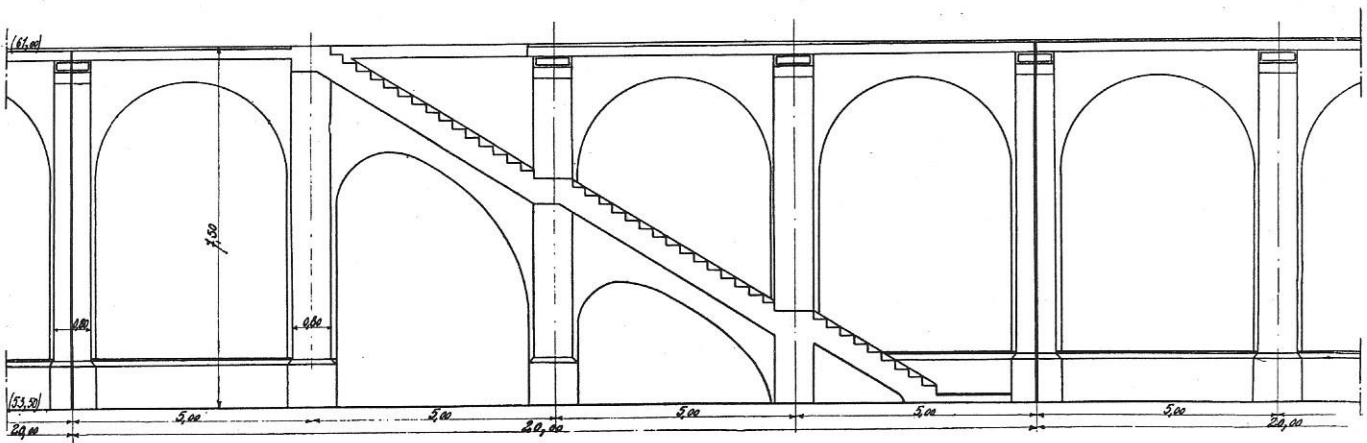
Vue en élévation de la face arrière du mur-digue.
